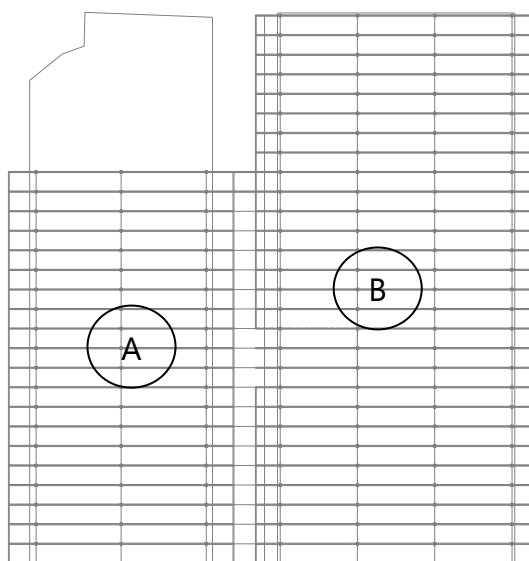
Esquema en planta de las naves (elaboración propia).
